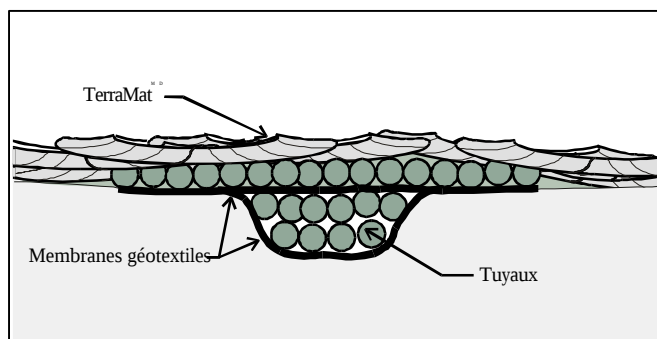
Coupe transversale de la structure utilisée au 2^e essai
